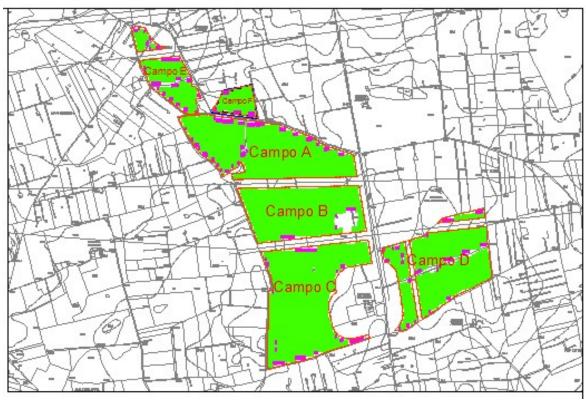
LAYOUT DEI PANNELLI NELLE AREE DI INTERVENTO (LA PLANIMETRIA È PURAMENTE INDICATIVA)
